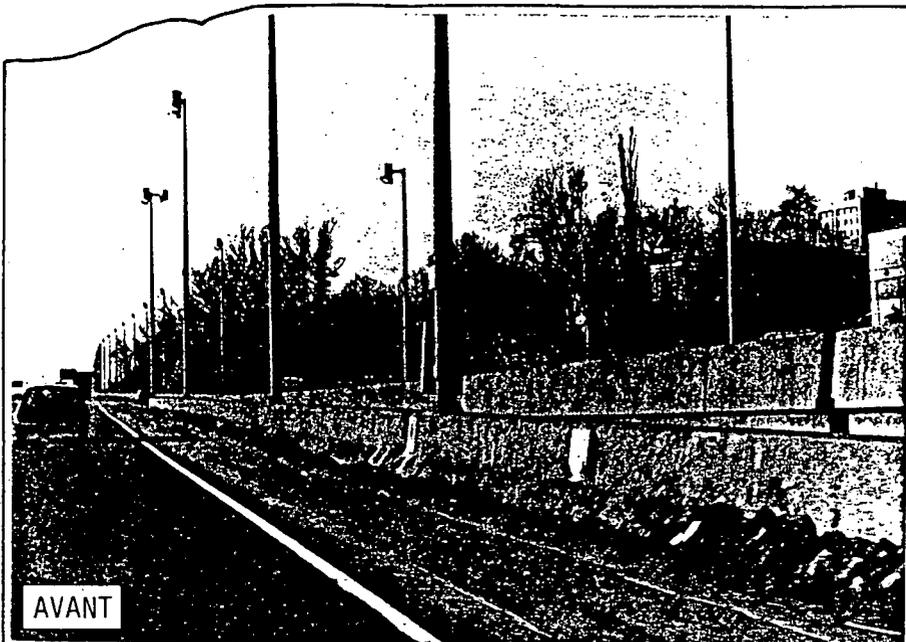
VUE EN PERSPECTIVE: RUE LEWIS
